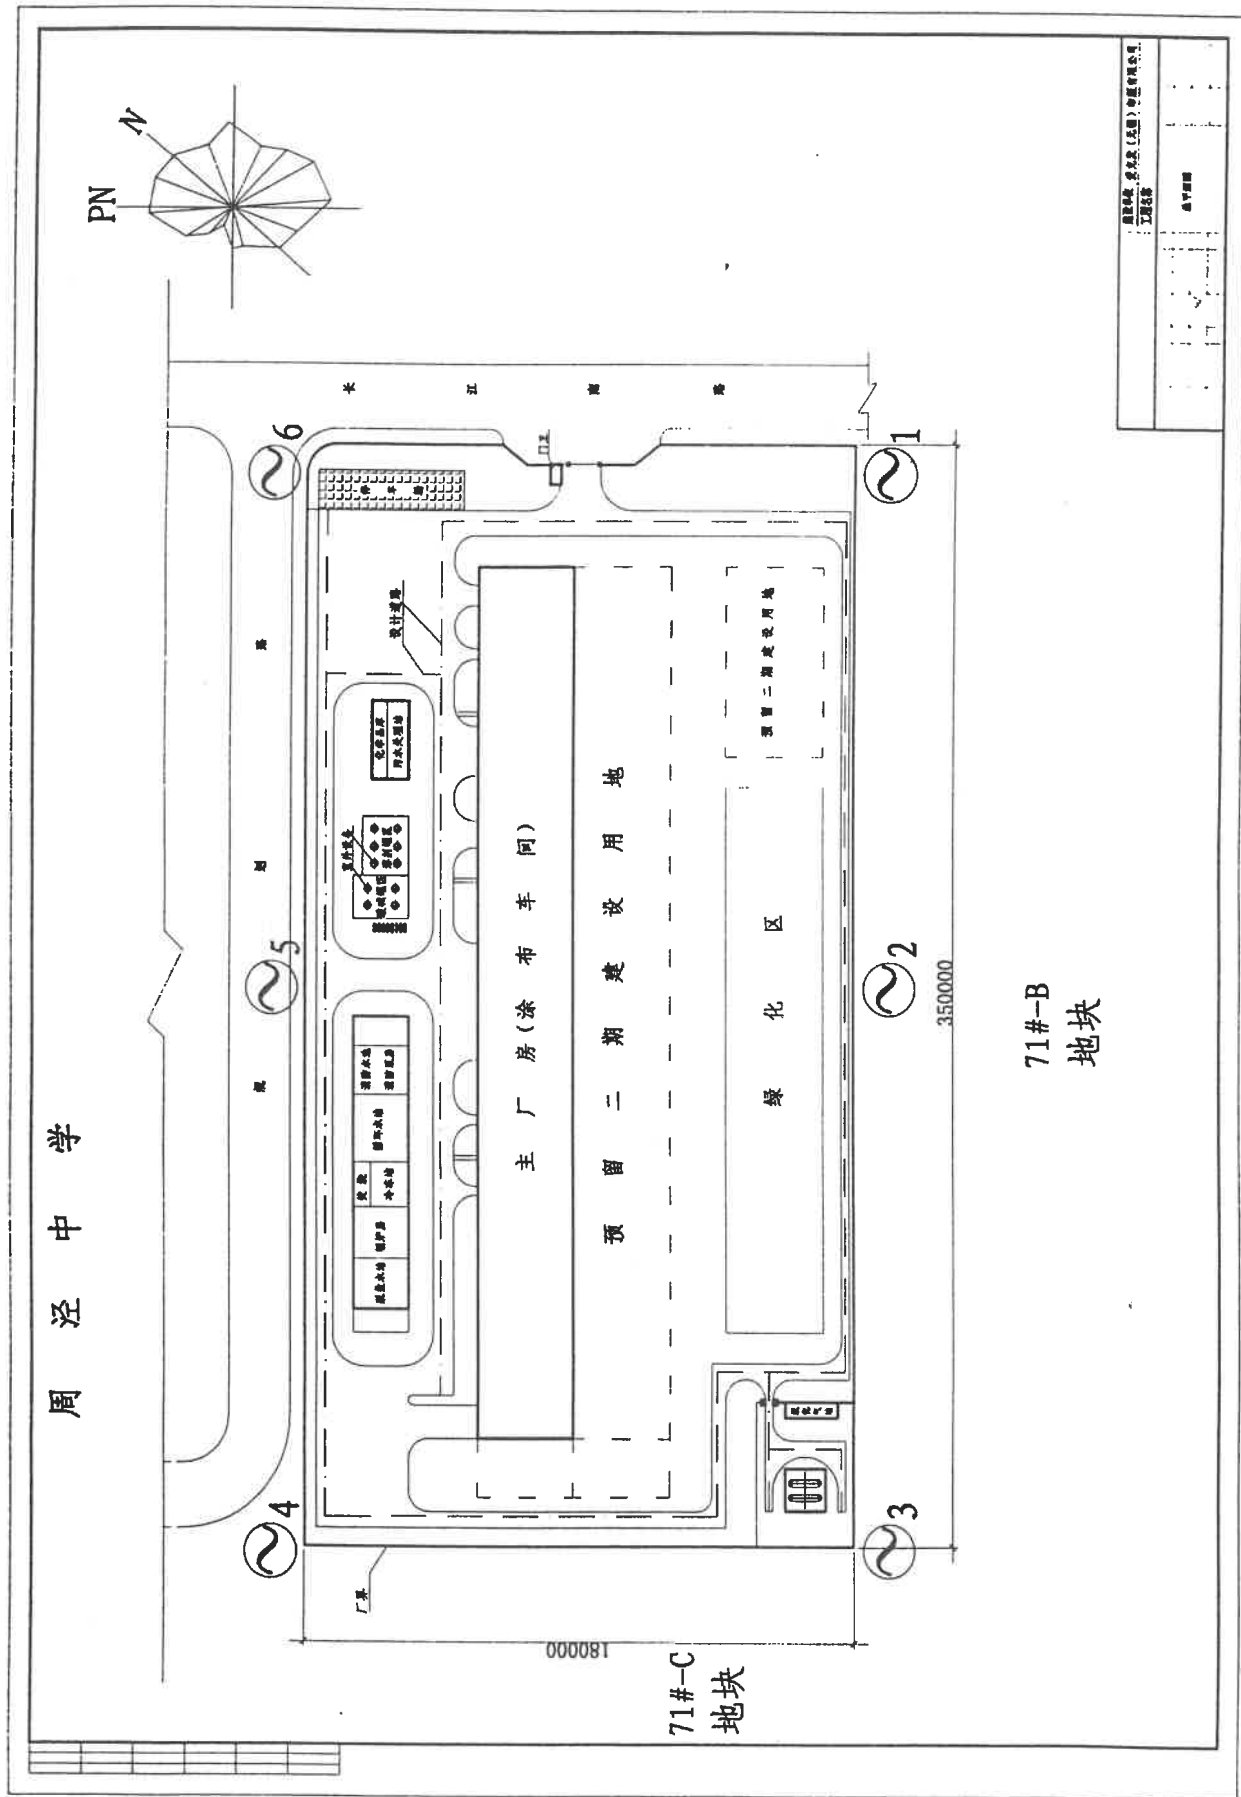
项目总平面布置图 (附厂界噪声监测点位图)
